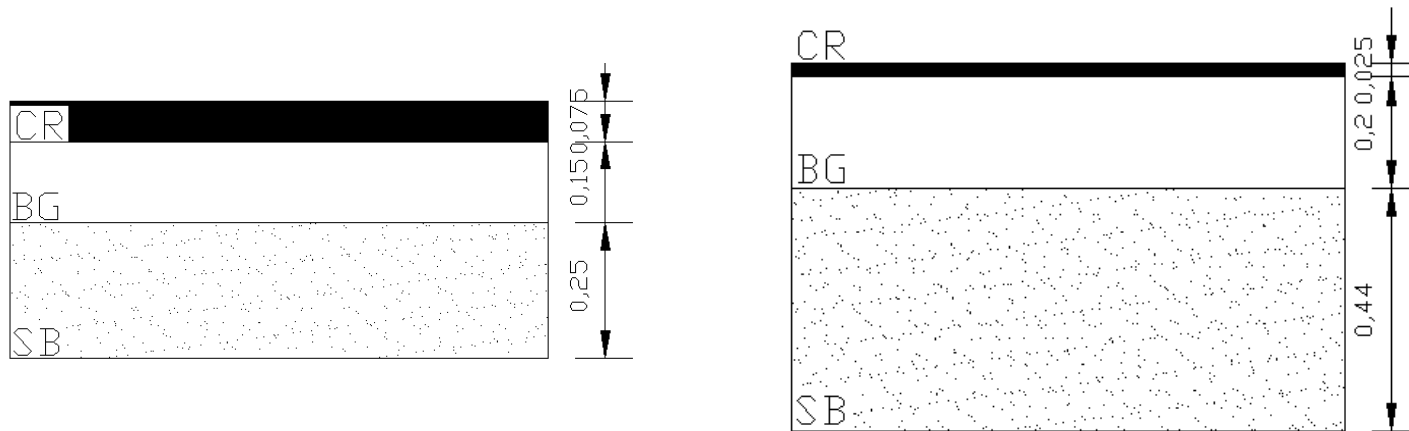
Diseño de Pavimento para CBR 5% - TPD Bajo
